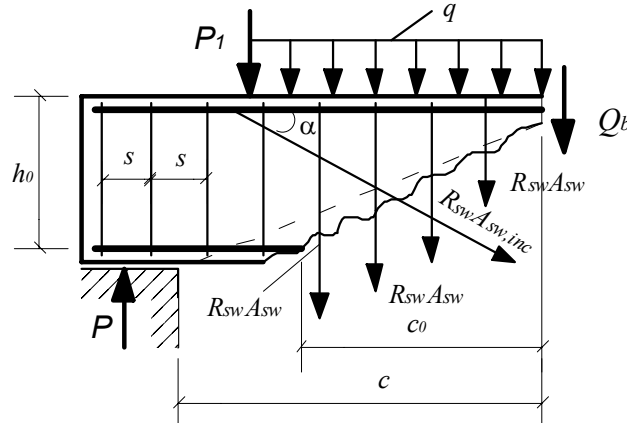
Розрахункова схема внутрішніх зусиль у похилому перерізі
